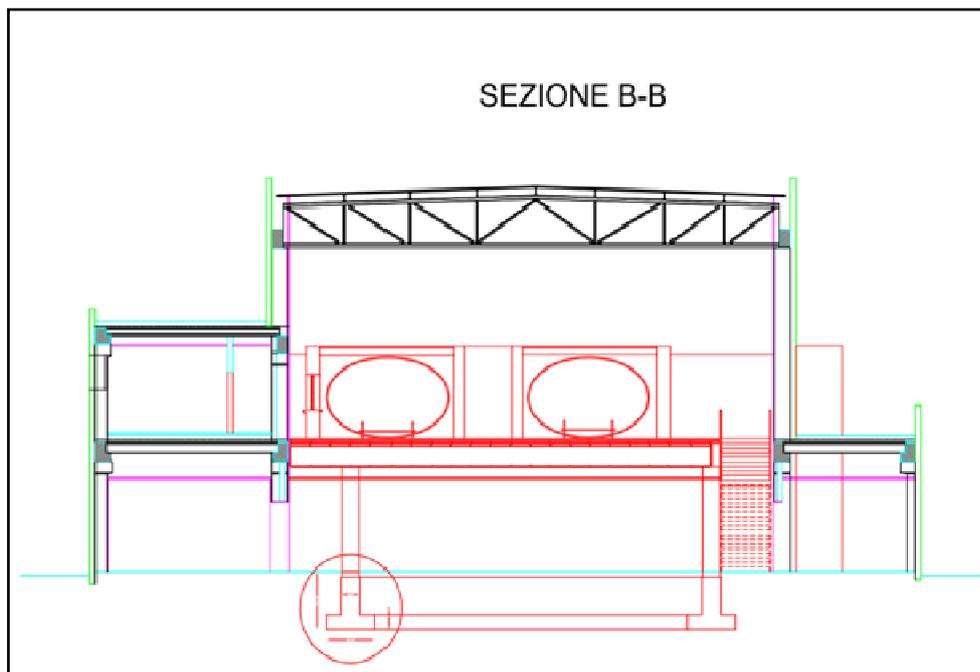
Stato di Progetto: sezione trasversale con indicazione del nuovo solaio e dell'ipotesi fondale in rosso
